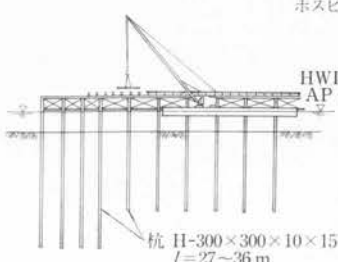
(A) 施工順序 (プレキャストケーソン製作ヤード施工)
